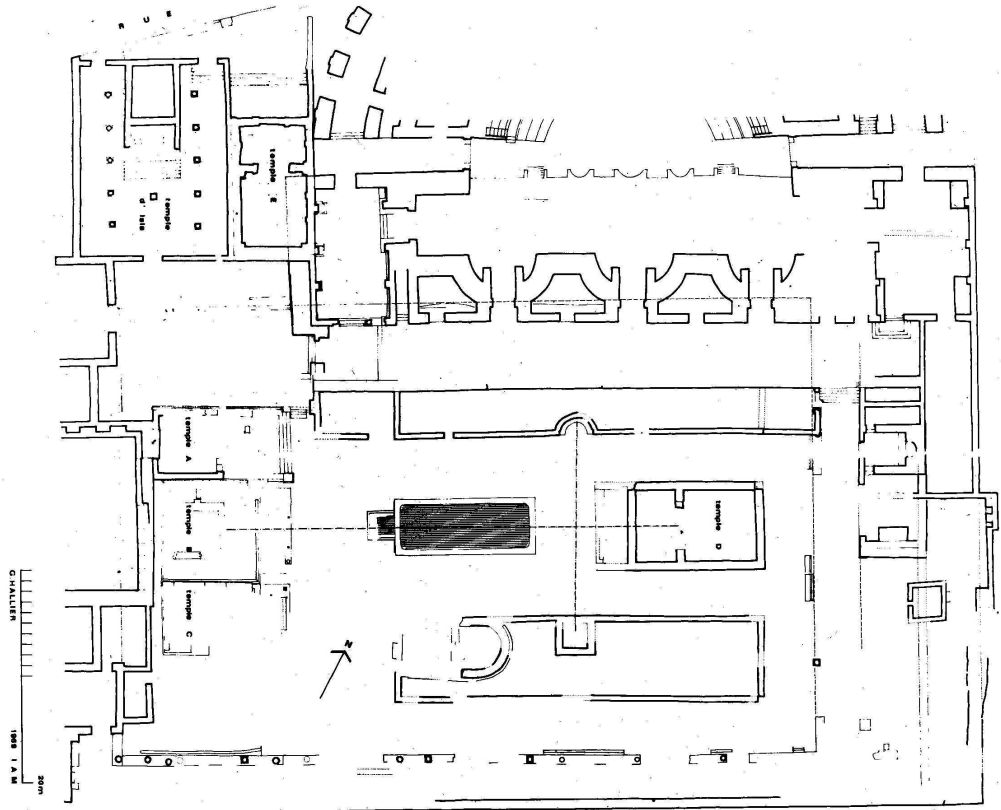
Plan de l'esplanade A située au sud du théâtre par G. Hallier dans Beschouch et *alii* (1977), p.102, fig.100.
